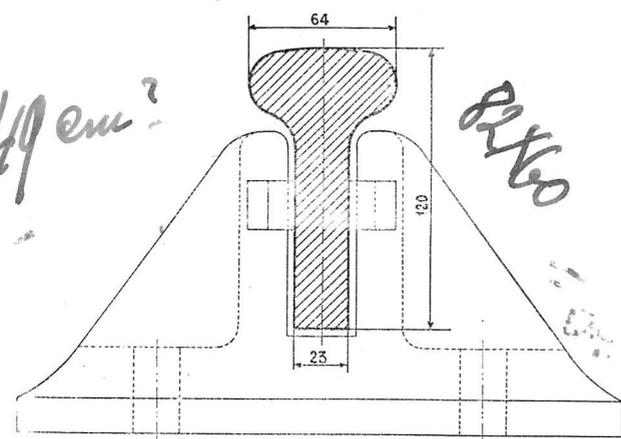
Rail en fer, à section uniforme, de 27 kg. par m. — 1838
